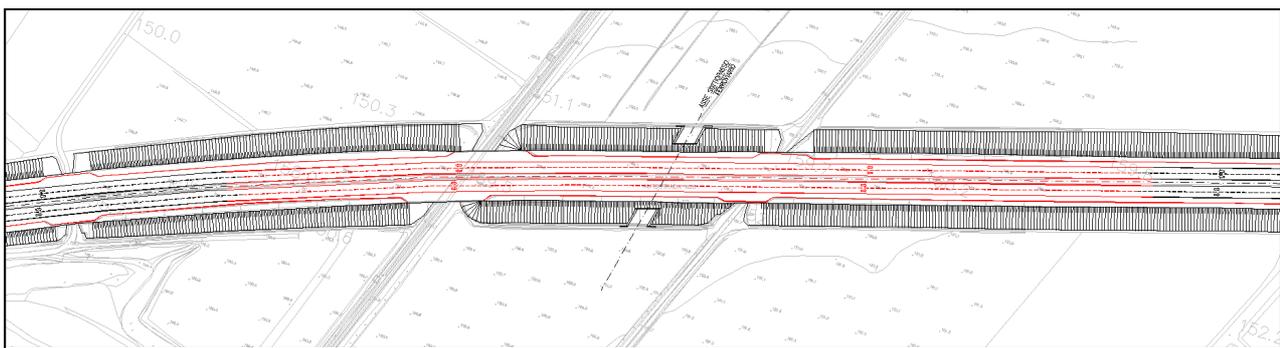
Planimetria fasi realizzative dell'opera. Fase 5
